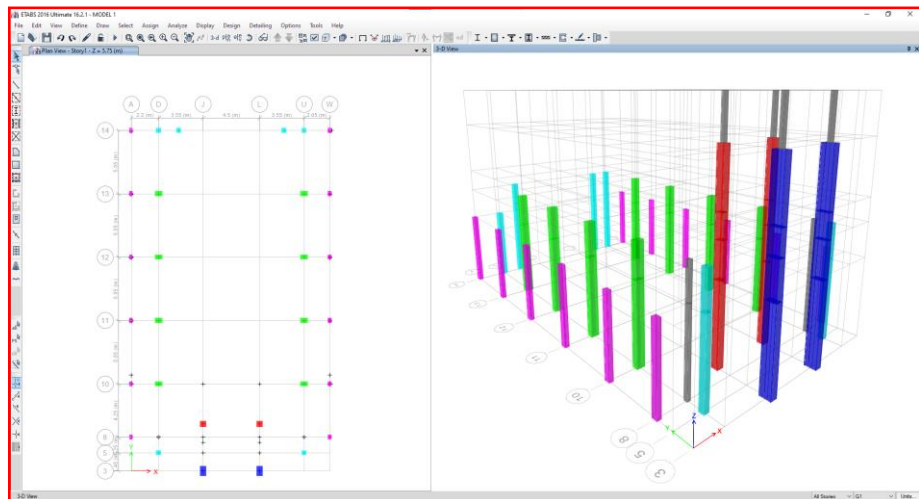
Vista Etabs N° 11 – Dibujo de columnas
